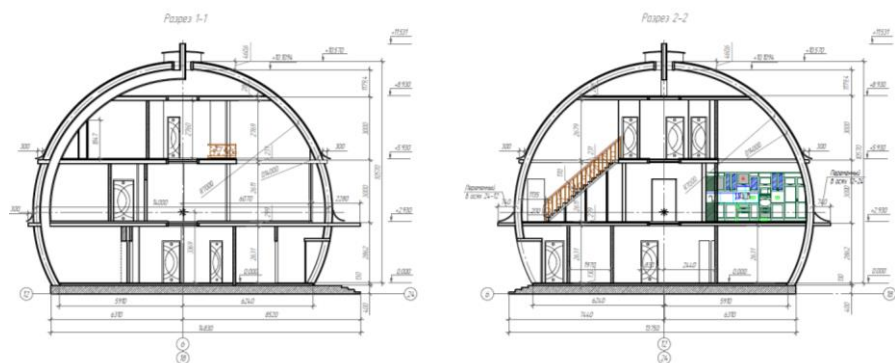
Продольный и поперечный разрезы жилого дома.
